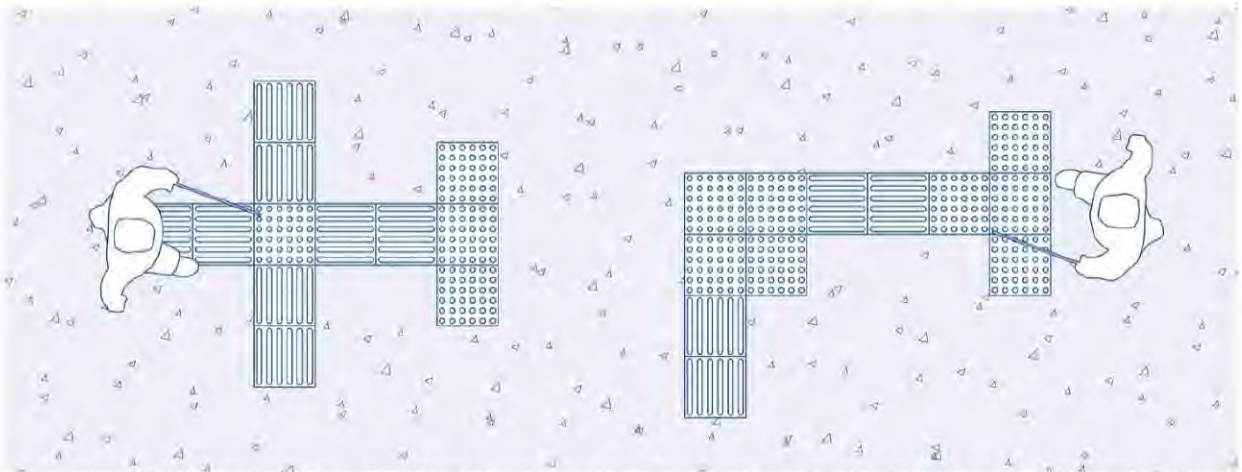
Pavimento de advertencia (baldosa de la izquierda) y el pavimento de orientación (baldosa de la derecha). Fuente: ArchDaily
